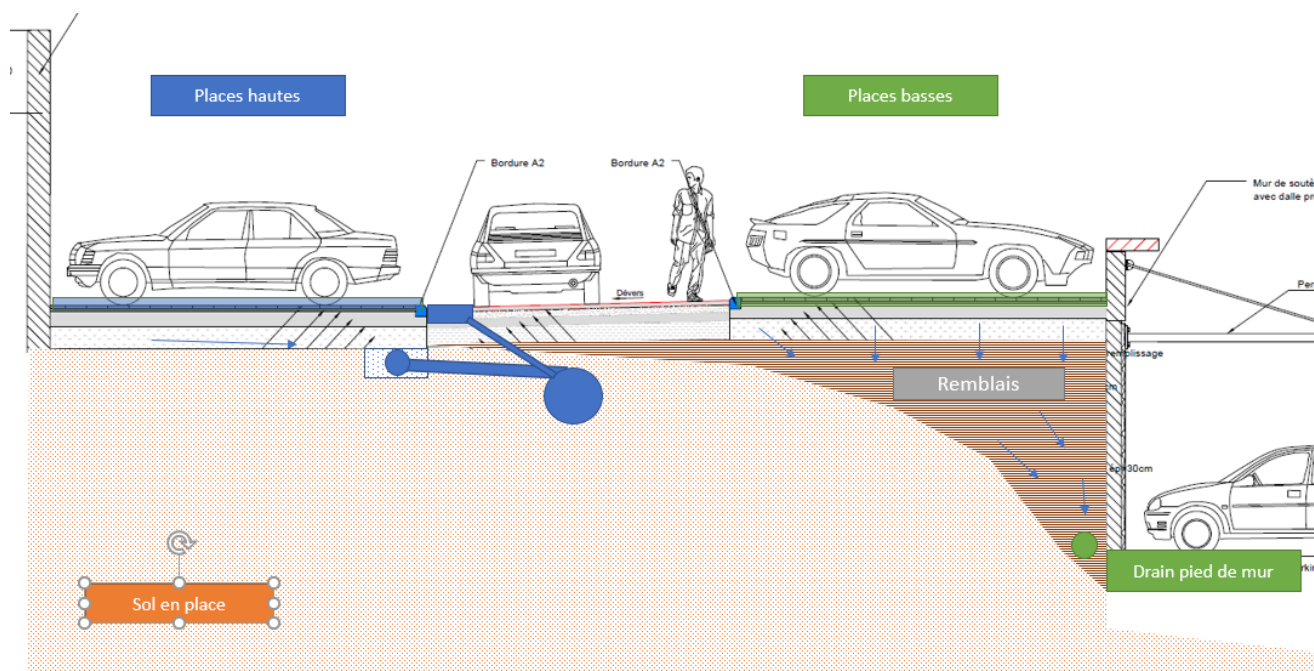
coupe schématique de la gestion pluviale sur les places de parkings.
